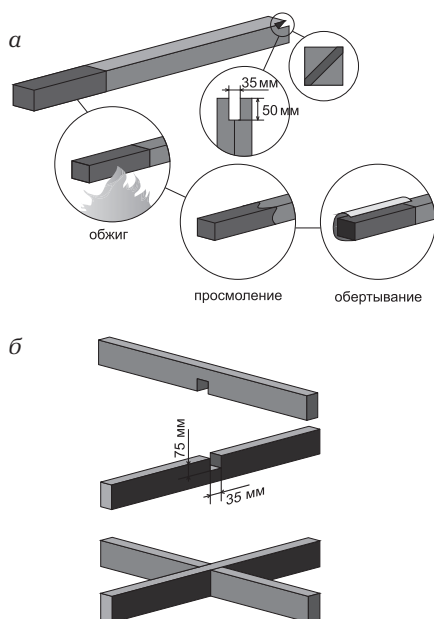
Подготовка опор (а) и сборка крестовины (б)
